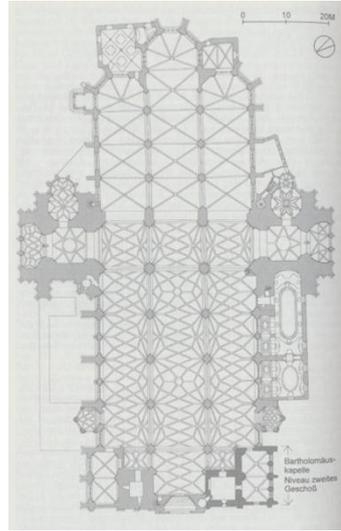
Wien, Stephansdom, Grundriss
